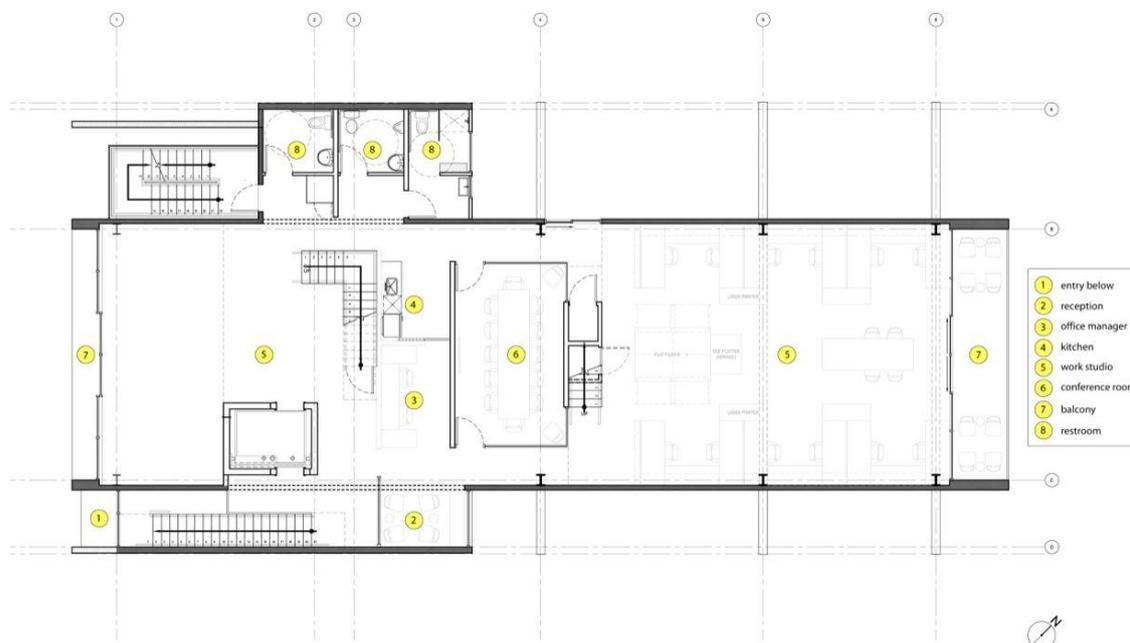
20th St. Offices – Planta primeiro pavimento
